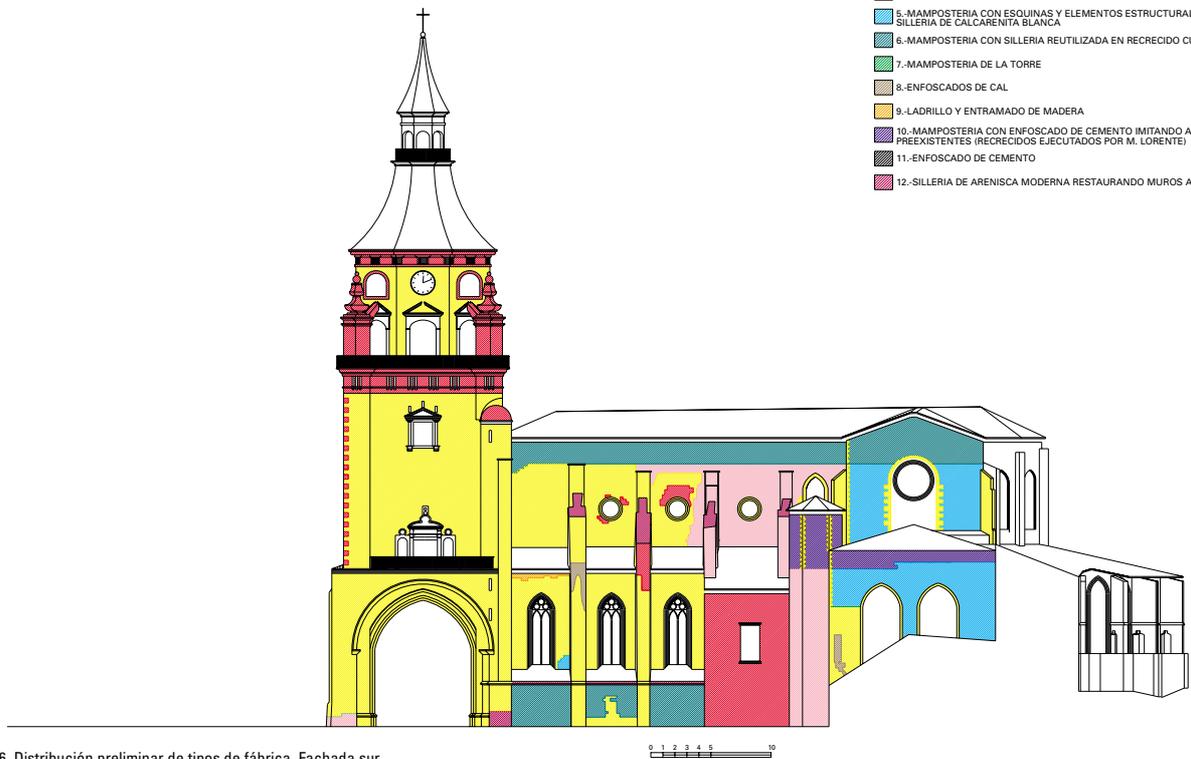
Distribución preliminar de tipos de fábrica. Fachada sur
